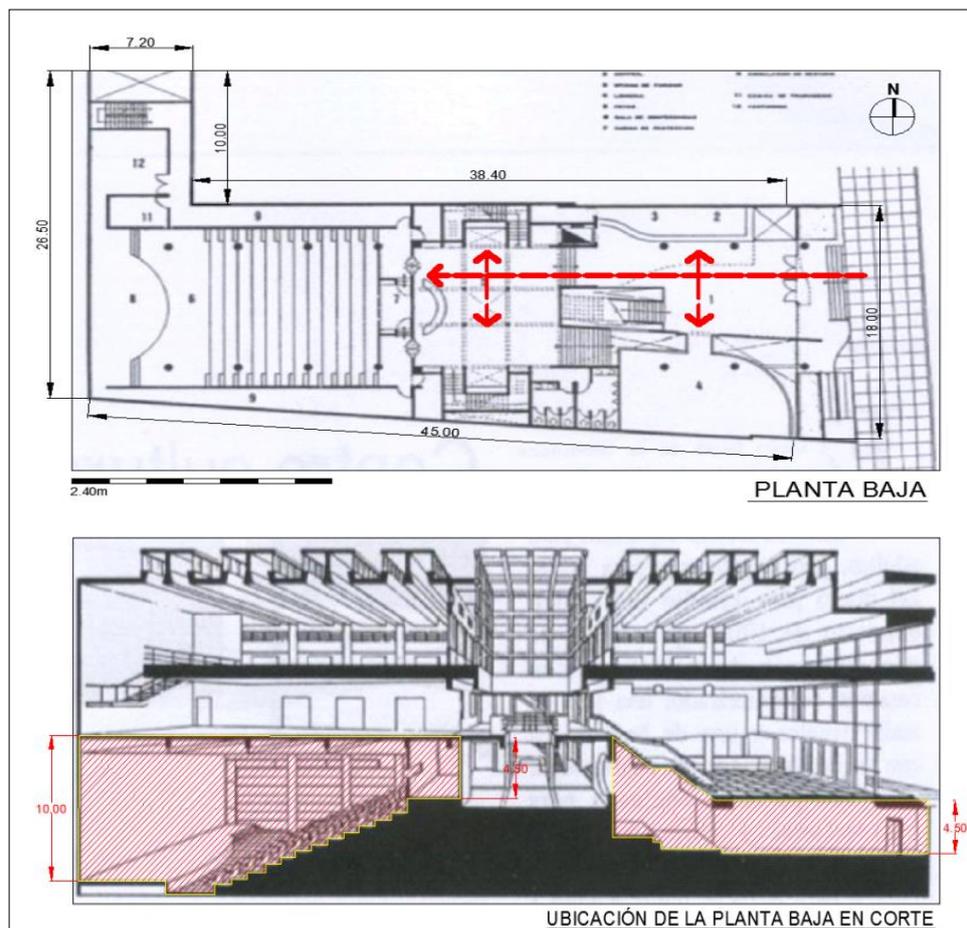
Plano y corte de la planta baja del centro cultural Ricardo Palma.
